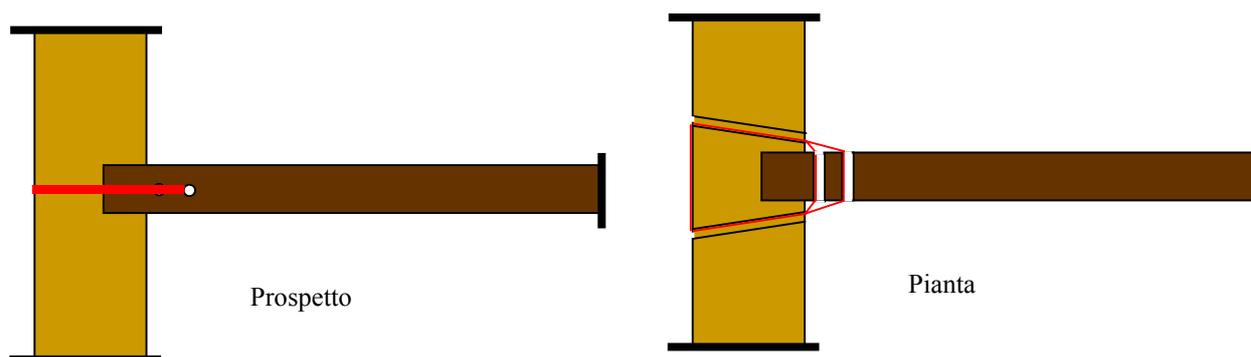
Schema di collegamento di trave in legno con la parete muraria.
